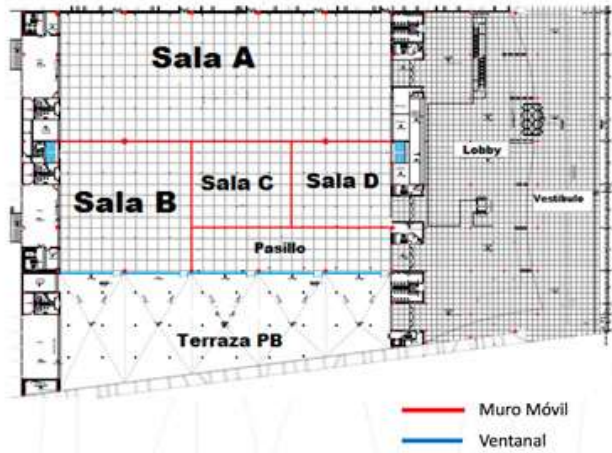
PLANO DE LA PLANTA BAJA DEL SALÓN GRAND FUENTE: <http://qcc.mx/es/instalaciones/planos/1/qcc/>
